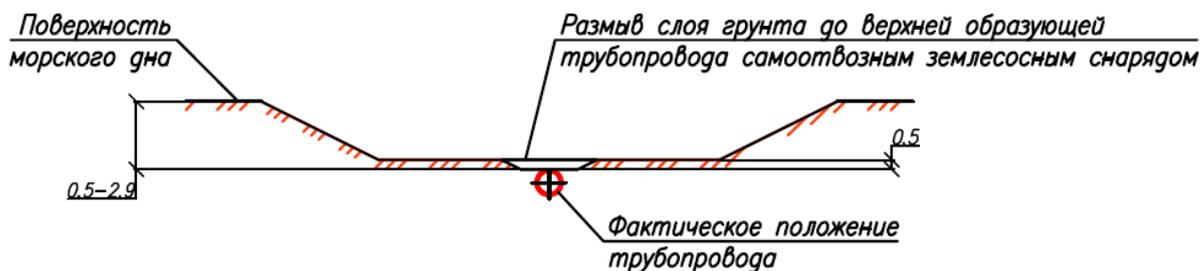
Разработка слоя грунта самоотвозным землесосным снарядом
